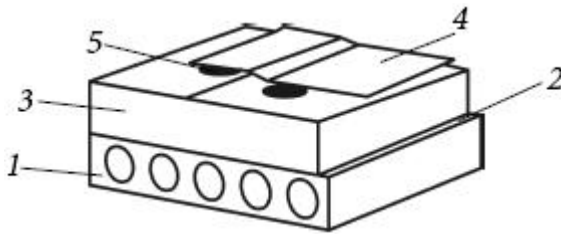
Наружная однослойная теплоизоляция плоской кровли: 1) несущая плита; 2) слой пароизоляции; 3) утеплитель; 4) цементно-песчаная стяжка; 5) слой гидроизоляции
